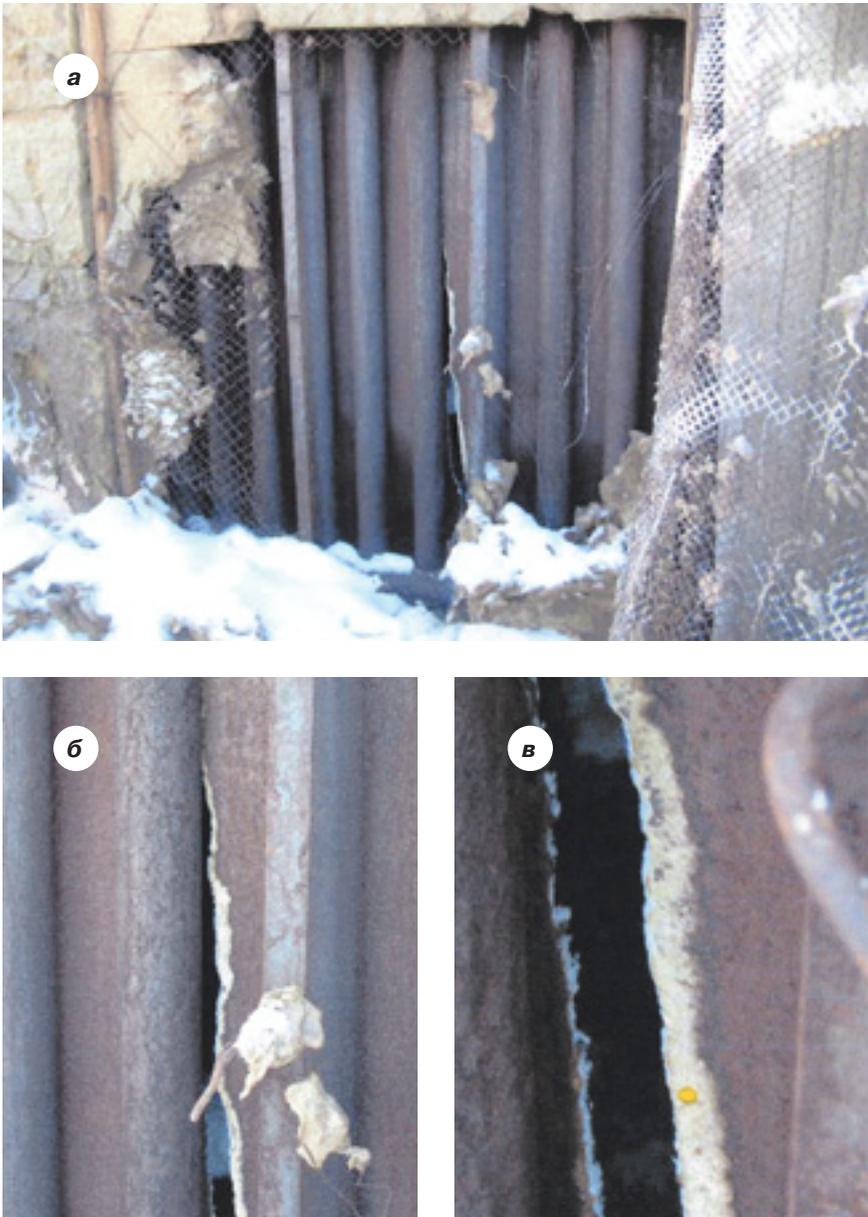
Аварийный резервуар в ОАО «Карболит»: а – разрушенная обечайка; б и в – трещина в корпусе резервуара
